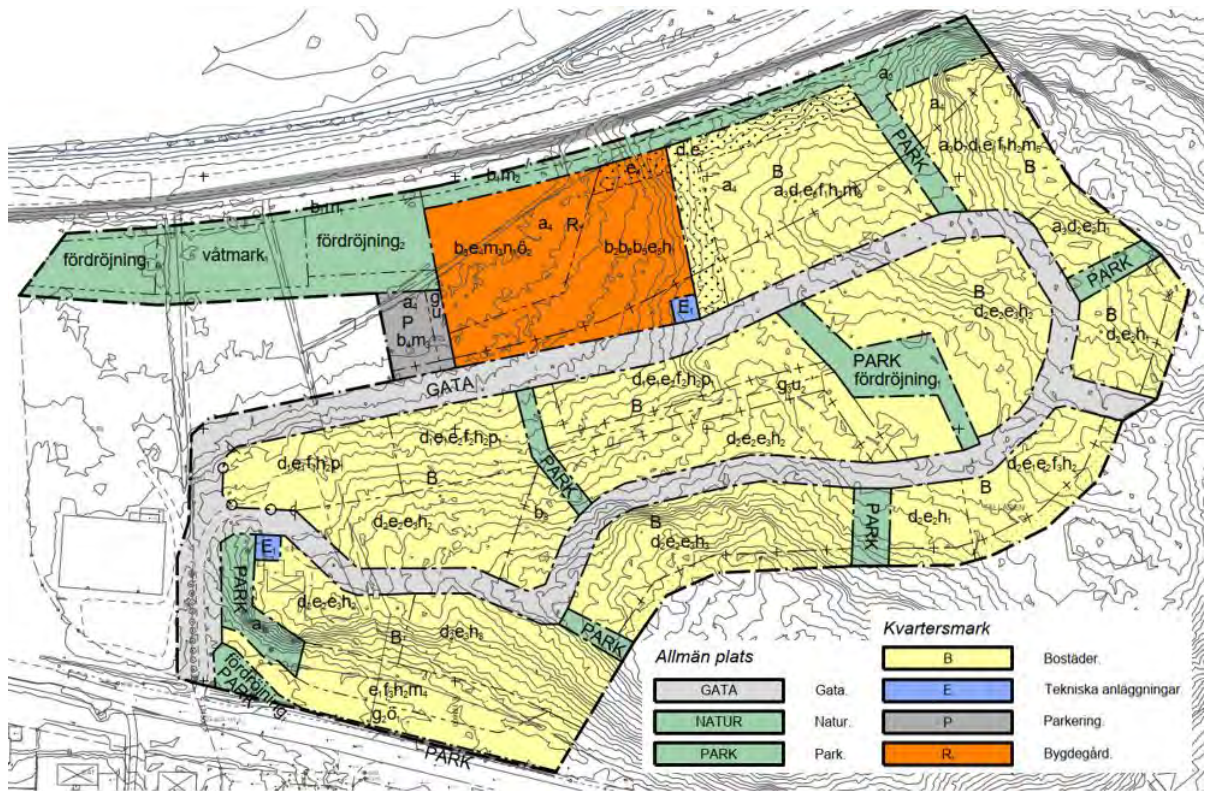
Planskiss Jagbacken, Etapp 1 (Carlstedt Ark., 2025-01-31)
